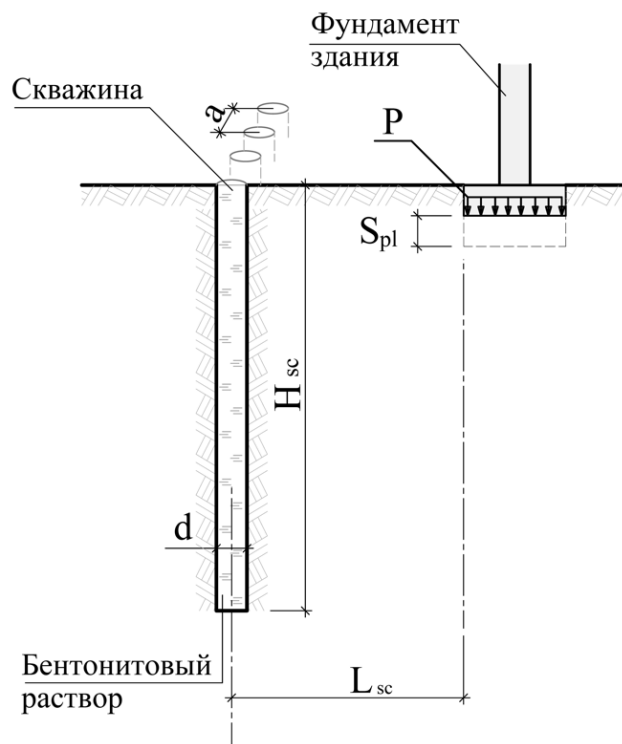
Расчетная схема этапа работ по устройству буровых свай
